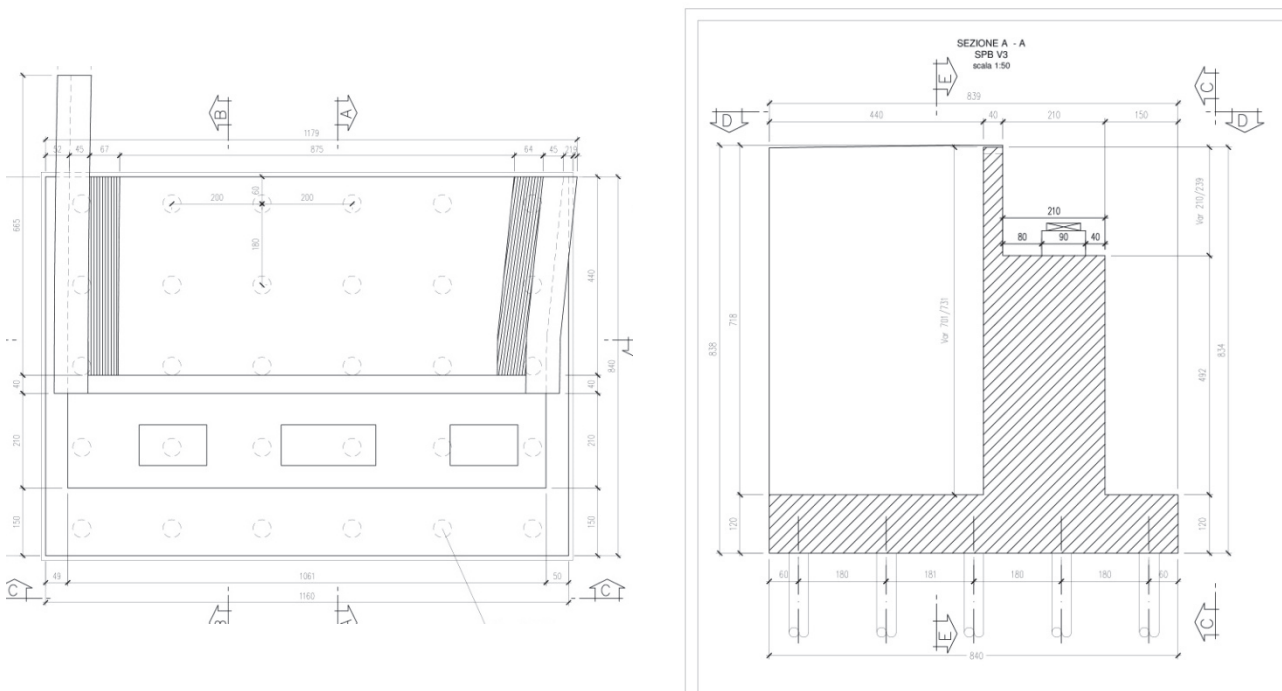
Spalla B: sezione longitudinale e pianta
